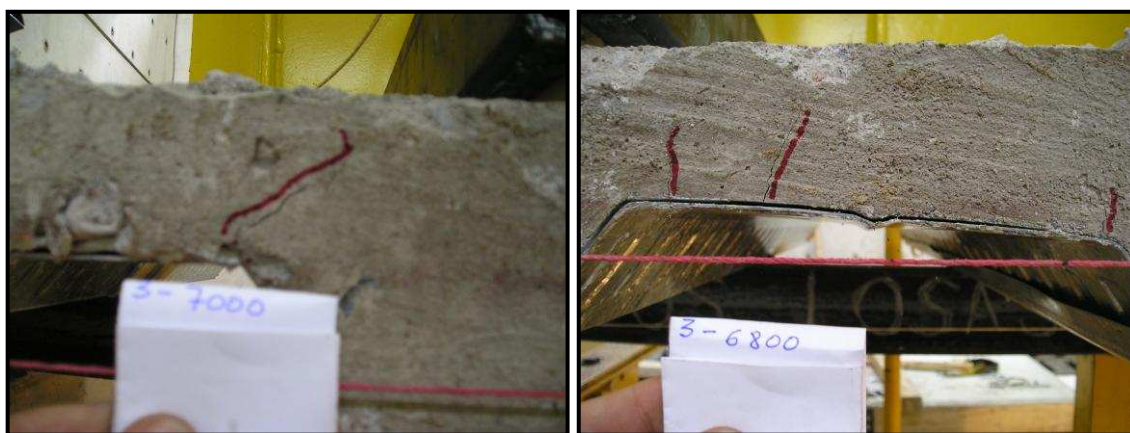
FISURAS QUE SE PRESENTAN EN LA LOSA DE HORMIGÓN.
